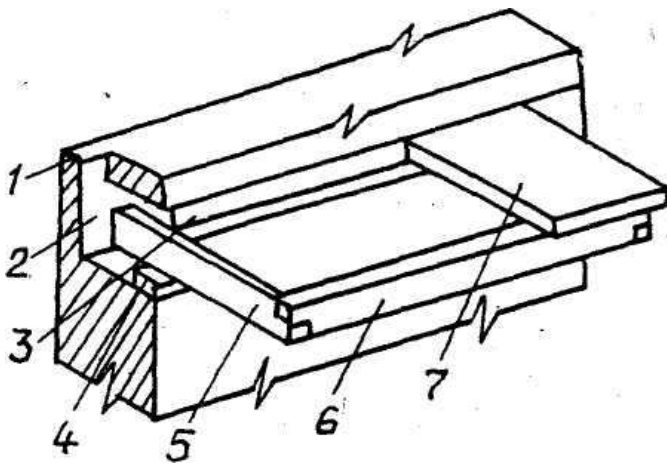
Збірний залізобетонний балкон харківської конструкції:
